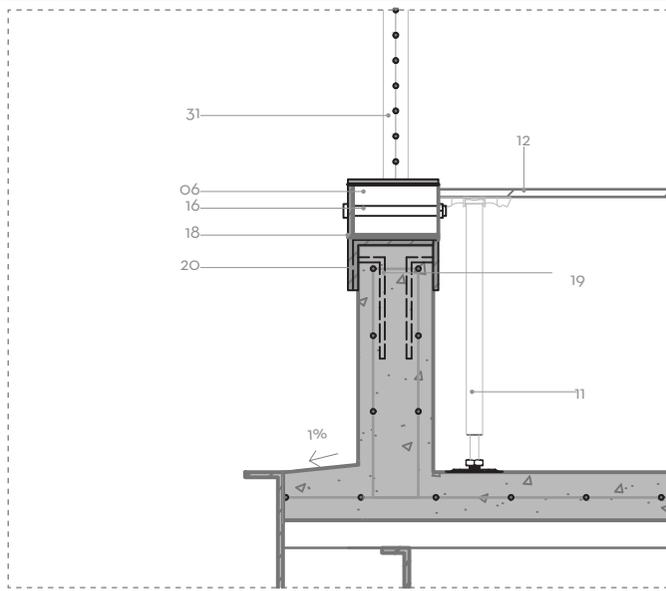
Det_e03. Anclaje tipo para pasamanos en muro perimetral. Fuente: Los autores Escala: 1,15
